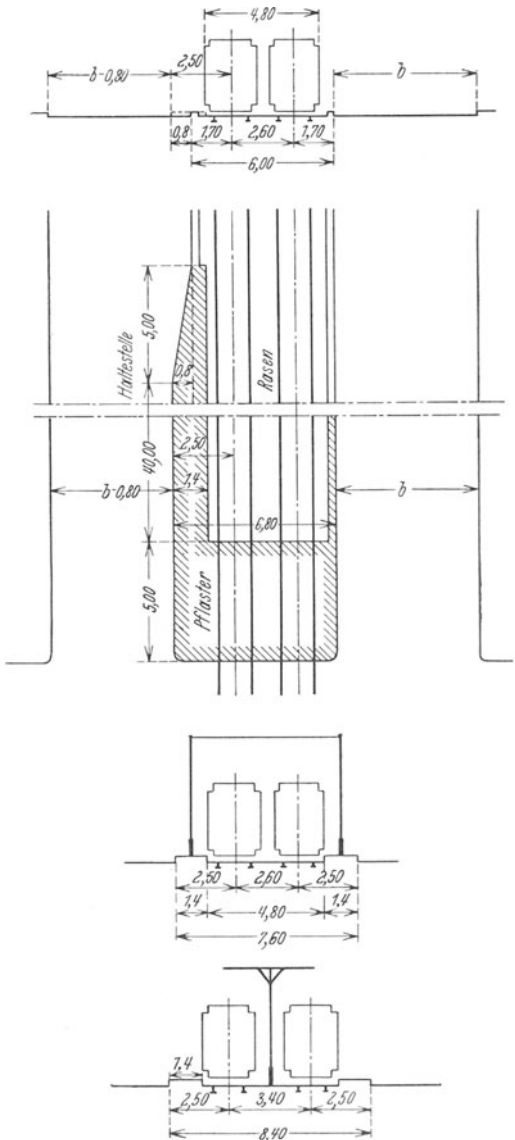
Abmessungen des Straßenbahnkörpers und Anlage der Haltestellen.
